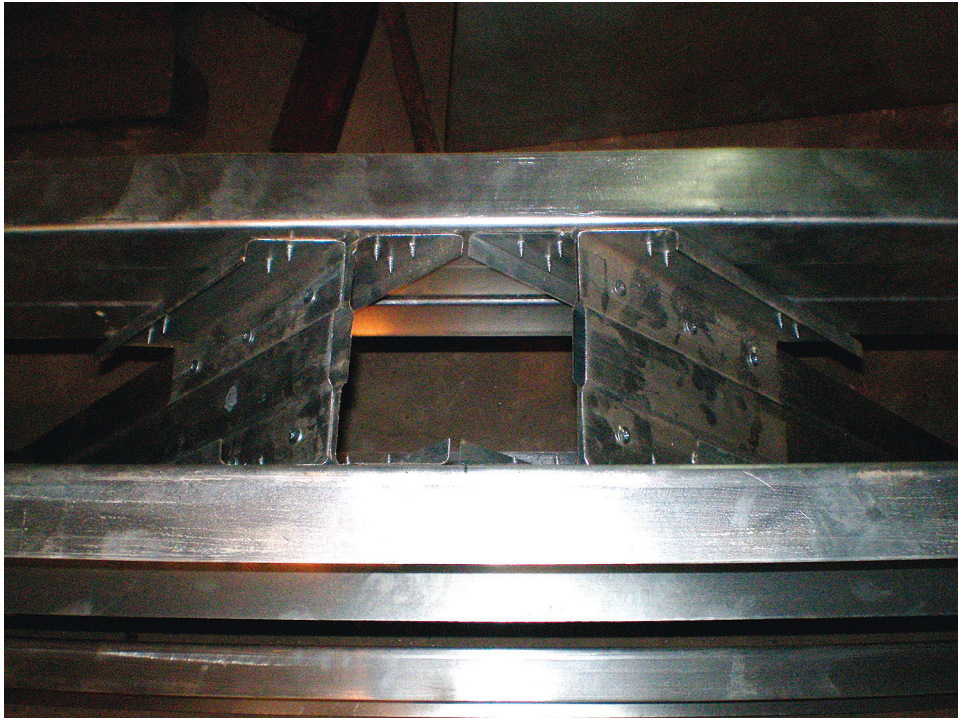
Усиление узла верхнего пояса фермы Ф3
